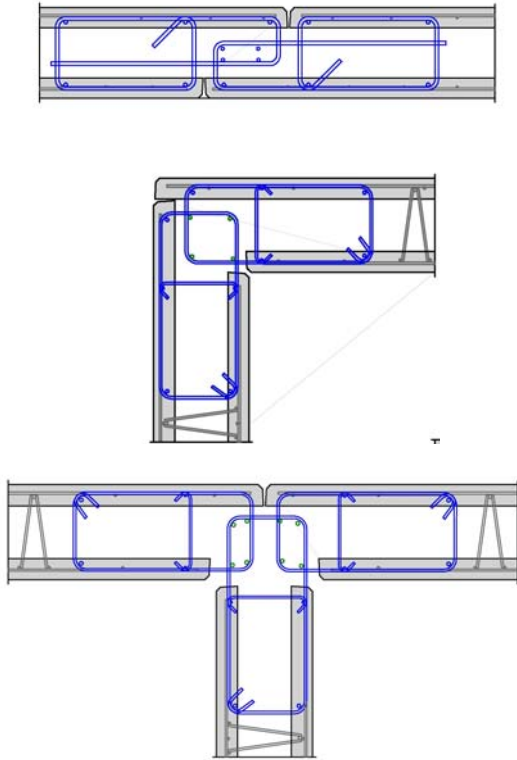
Exemples de joints verticaux compatibles avec solutions A ou B en pied
